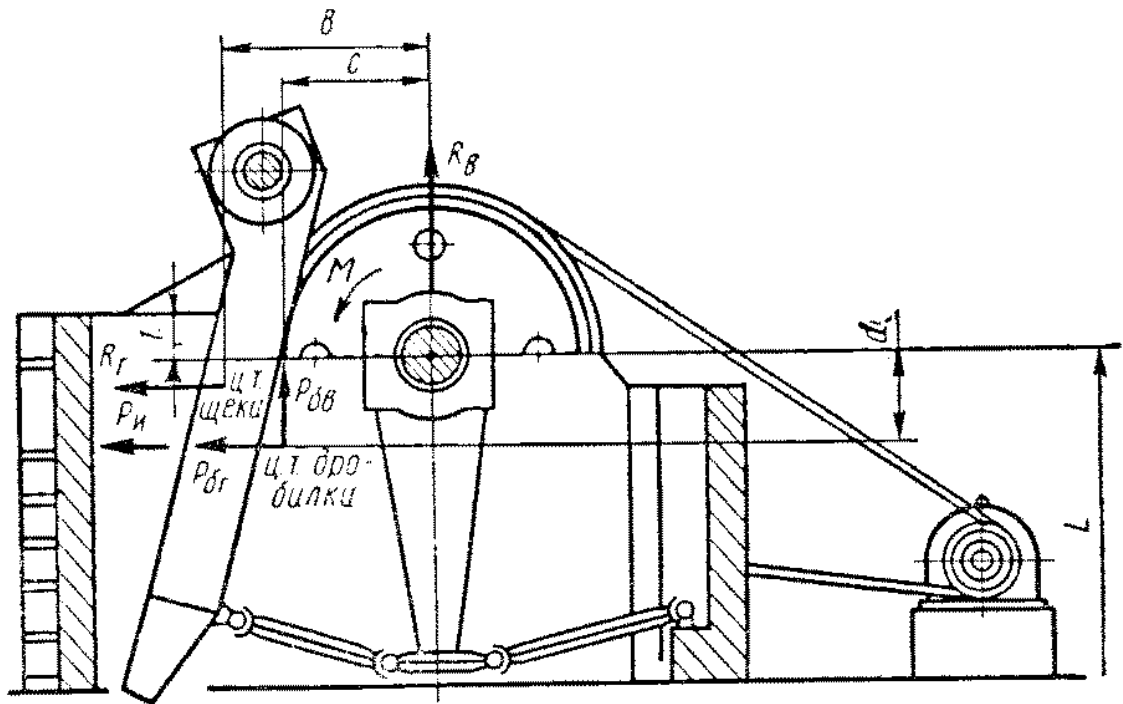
Навантаження на фундаменти дробарок типу ЩДП
